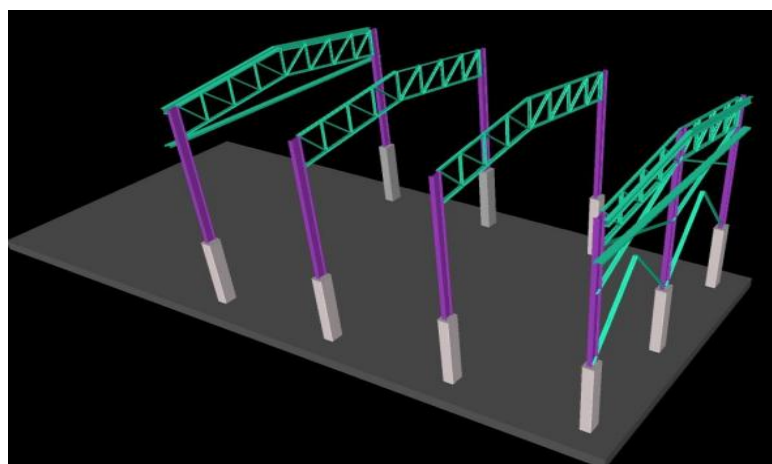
Montaje de columnas, cuerdas y diagonales verticales
